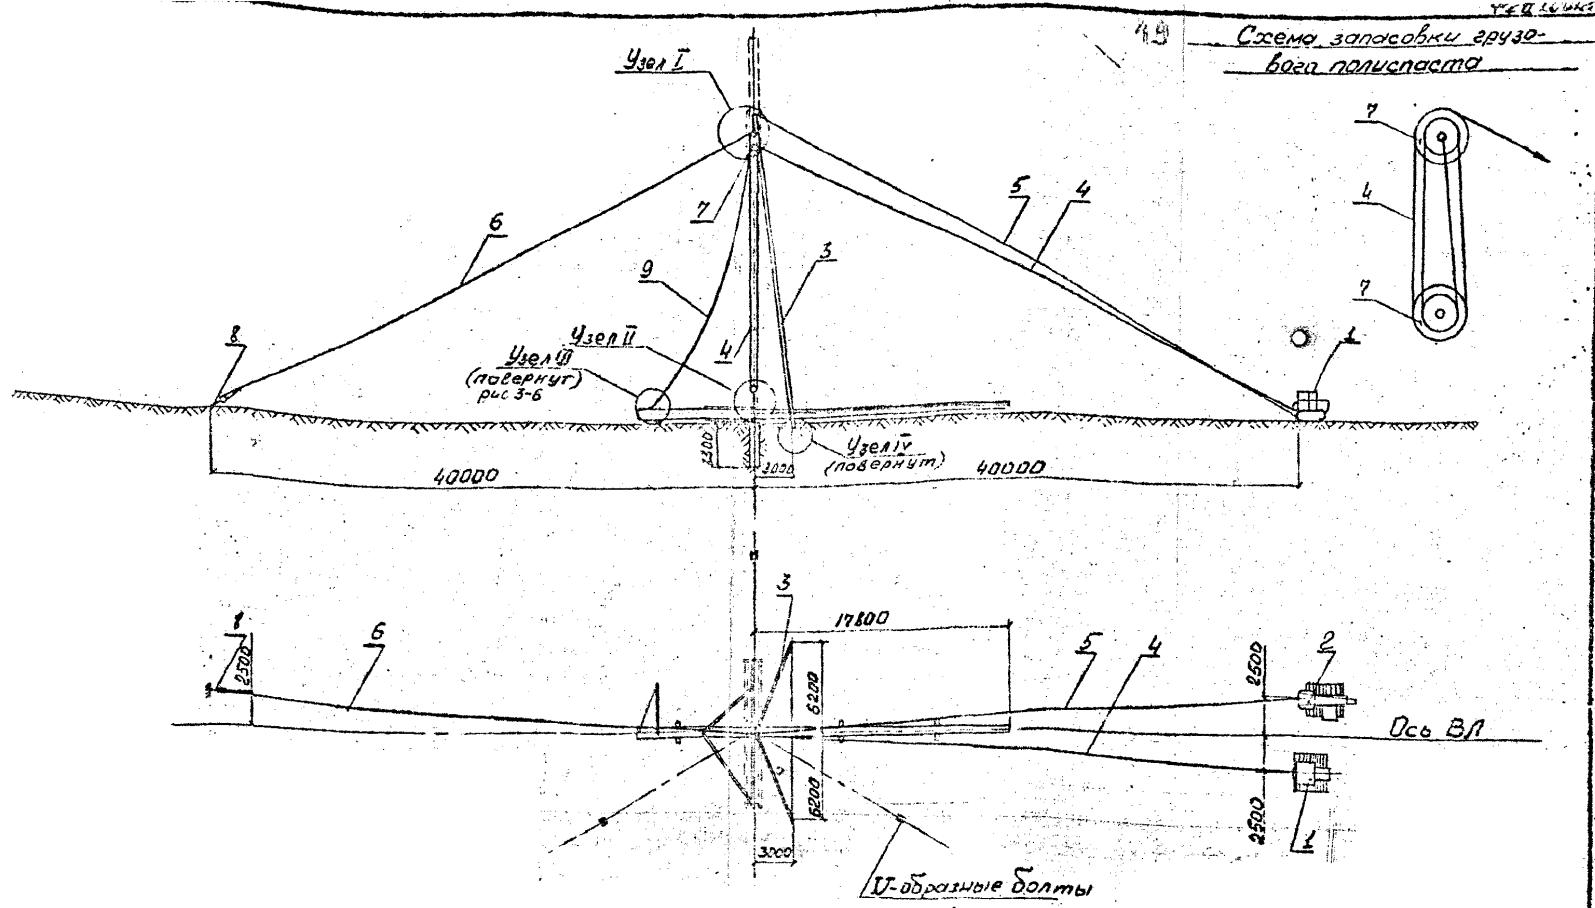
Схема подъема анкерно-угловых железобетонных опор
